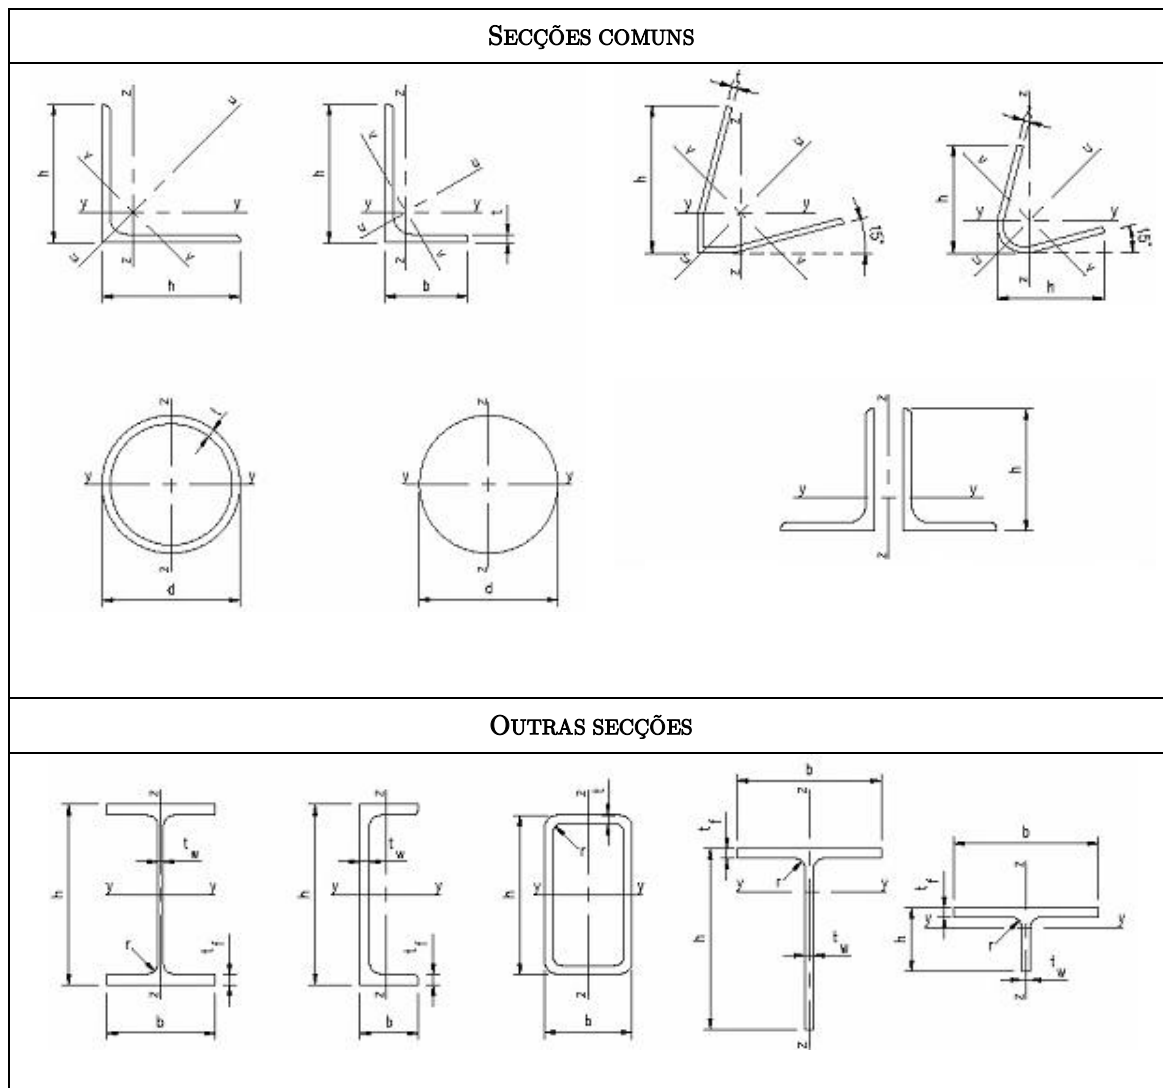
Secções transversais recomendadas (Fonte: EC3 3-1)
